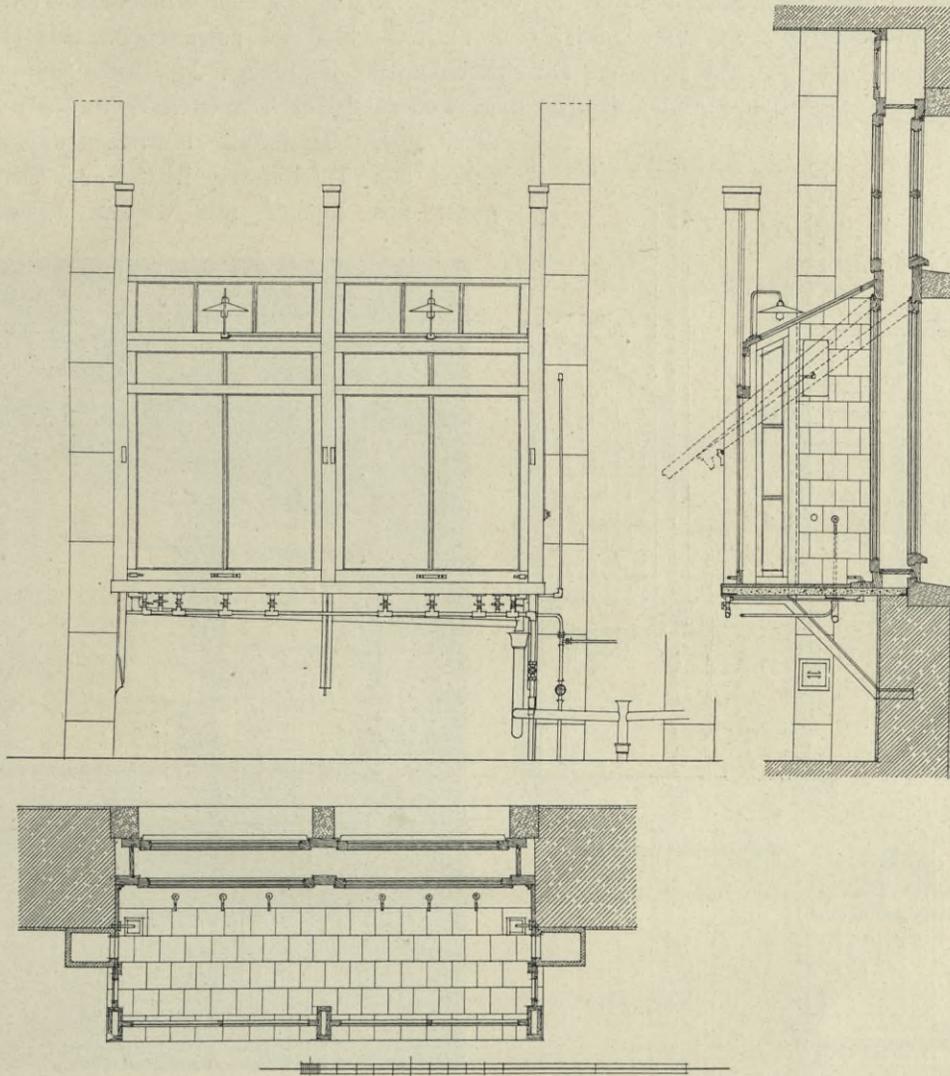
Fenster-Doppelkapelle mit Holzaufbau. Anorgan.-chem. Institut.
